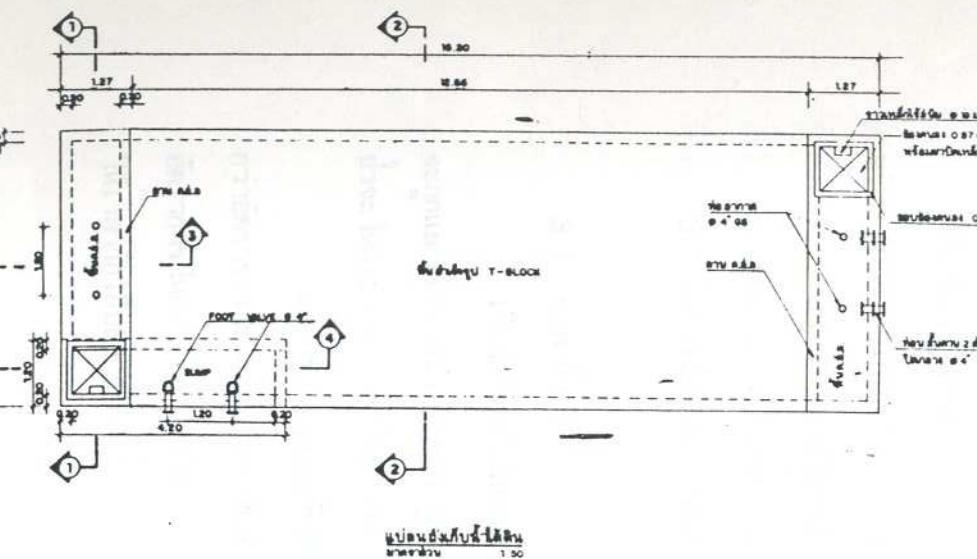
PLAN LAYOUT OF PLUMBING & SANITARY SYSTEM GROUND FLOOR
